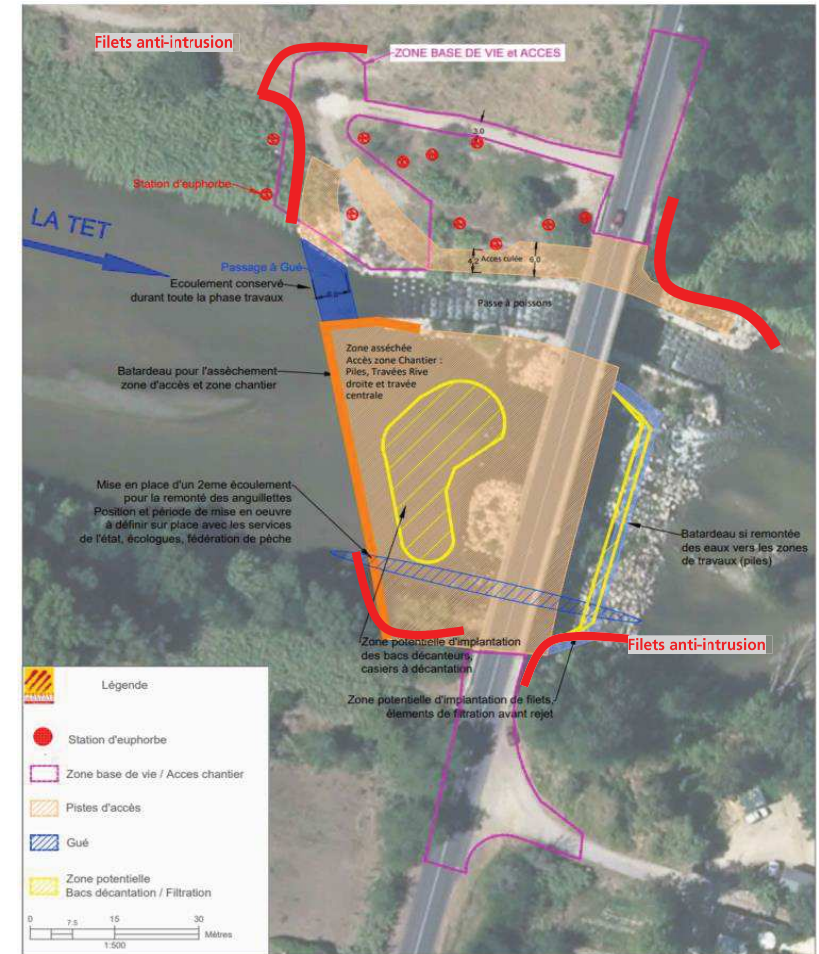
Plan de principe base de vie et accès chantier (Source : CD66)
